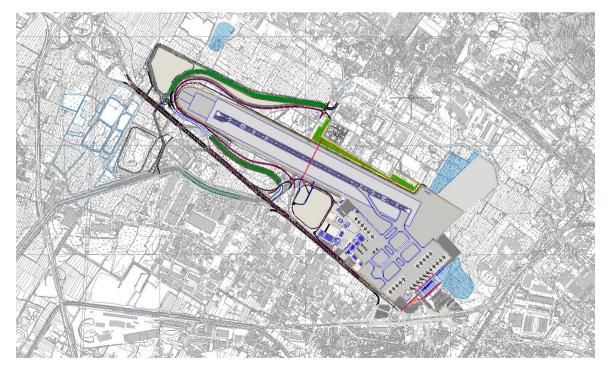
stralcio della planimetria di progetto dell'Aeroporto "Amerigo Vespucci"
